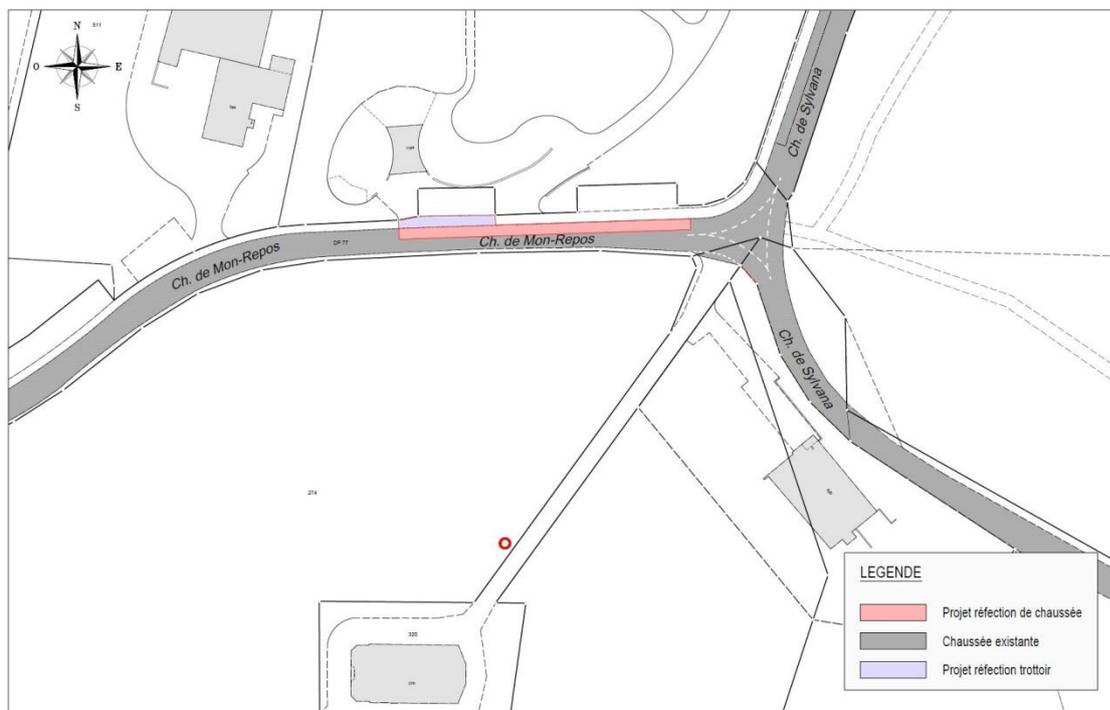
Plan des travaux sur le Ch. de Mon-Repos
